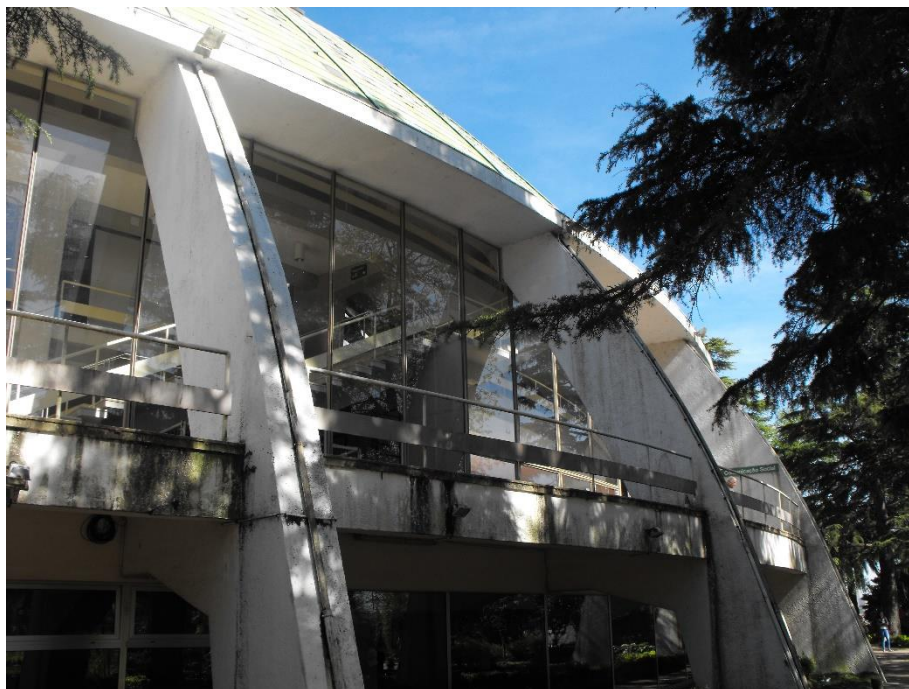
Pormenor do Pavilhão Rosa Mota
